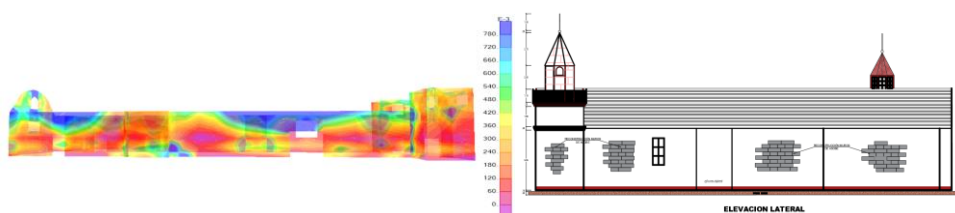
Grietas formadas a causa de esfuerzos a flexión en muro lateral.
